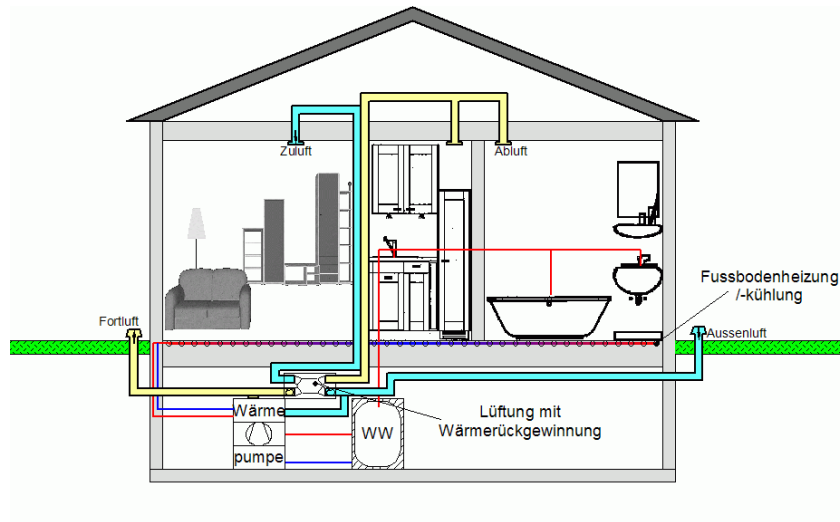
Standardsystem 2, Luft / Wasser – Wärmepumpe mit Umkehrbetrieb und einem gemeinsamen Wärmeübergabesystem
